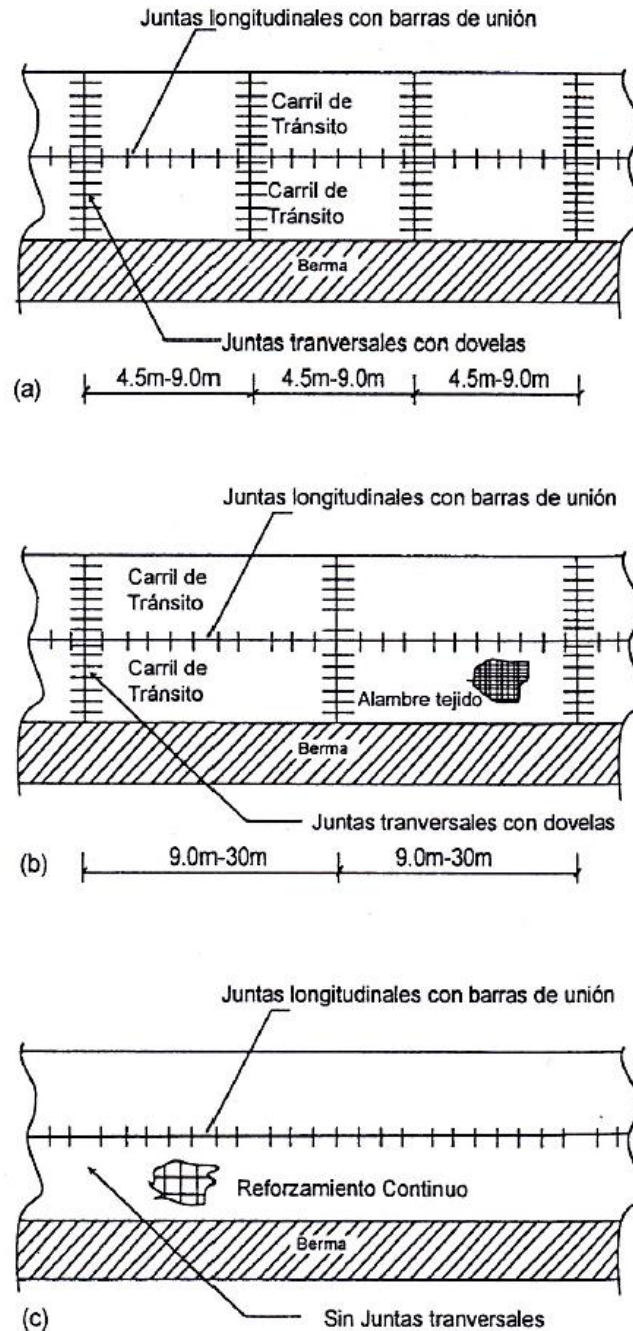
Tipos de pavimentos de concreto: a) losa simple con juntas (JPCP), b) losa reforzada con juntas (JRCP), c) pavimento de concreto armado continuo (CRCP) (delatte 2008)
